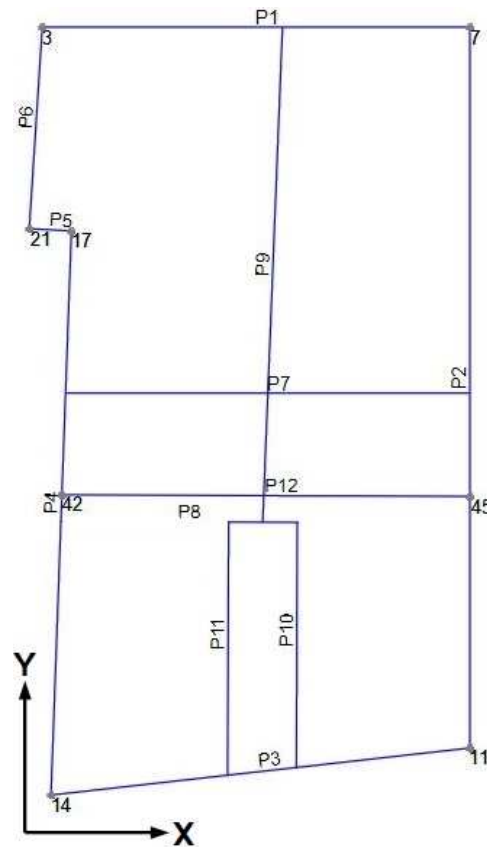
Modelo em planta do topo do primeiro piso: definição de nós e paredes.
